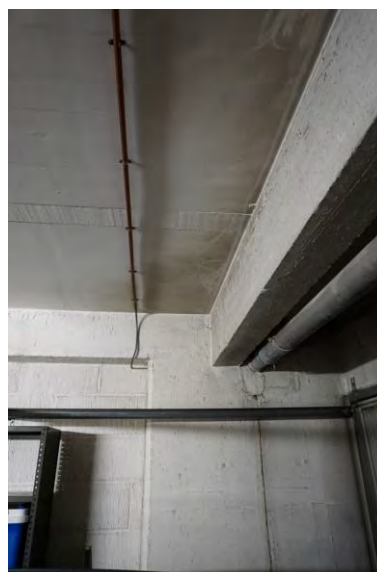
Garagebox 27 – tuinkant – ernstige vochtschade
